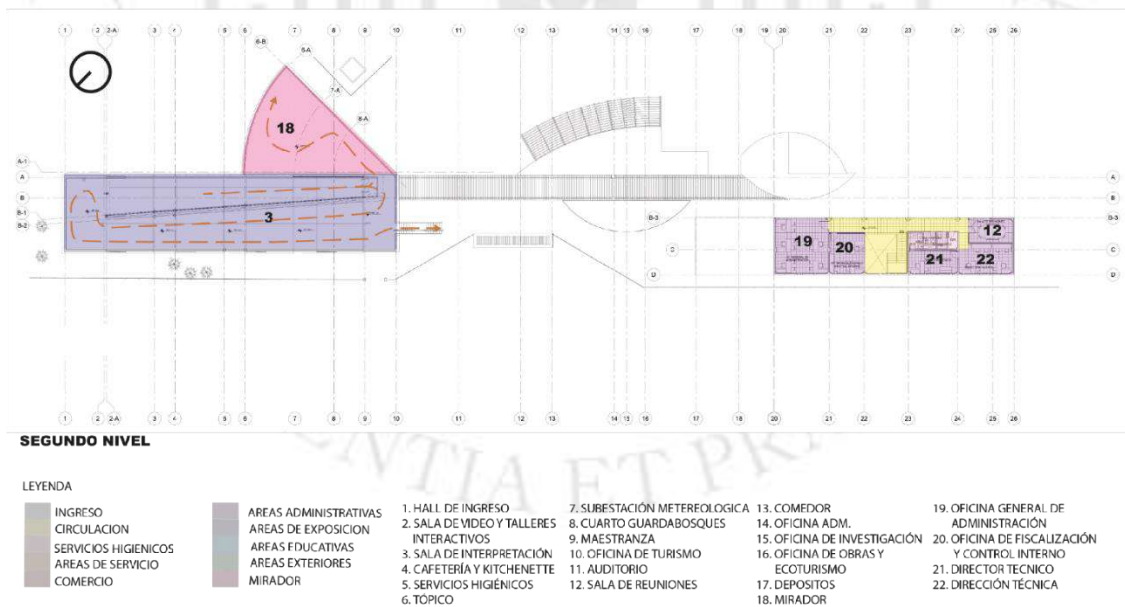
Segunda planta del CREA. Fuente: Arquitecta Vanesa Torres. Encontrado en Arrús y Mogollón, 2019
